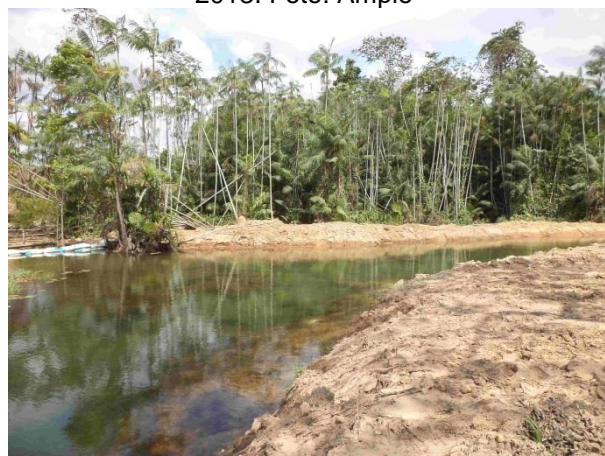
Jusante da travessia 164, em outubro de 2013. Foto: Ampla
